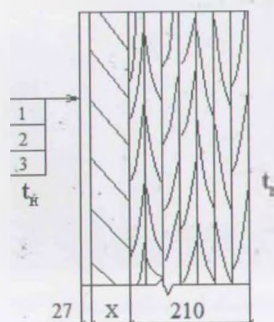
Конструкция стены: 1 – блокхаус; 2 – теплоизоляционный слой; 3 – брус из древесины сосны
